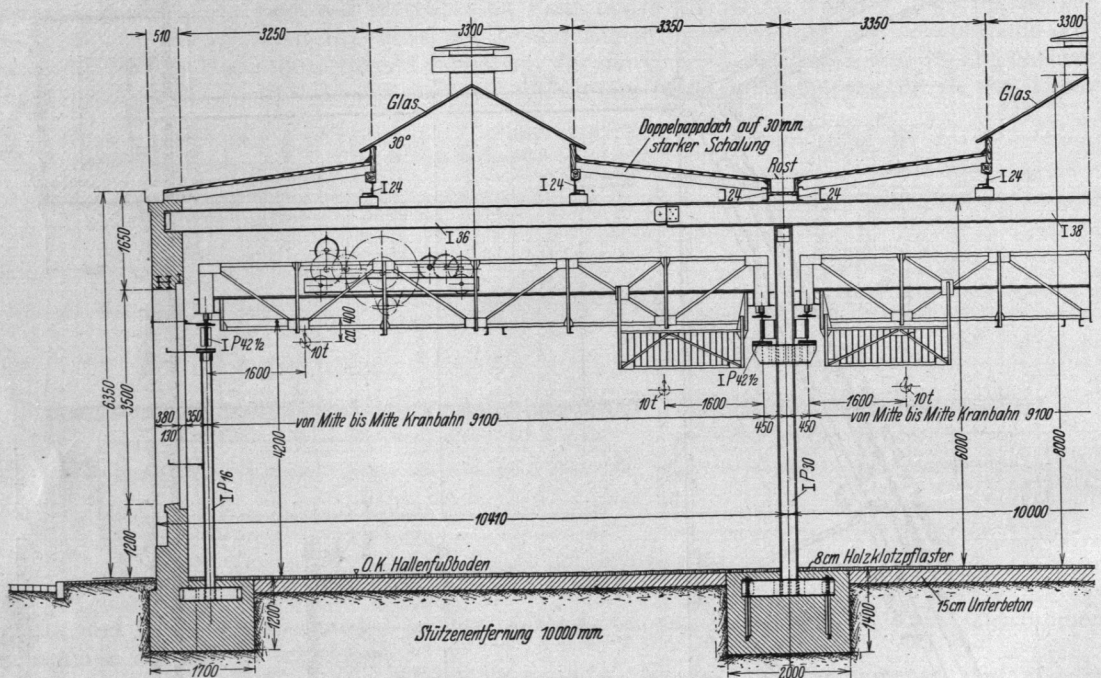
Mehrschiffiger Hallenblock mit massiven Umfassungswänden.
